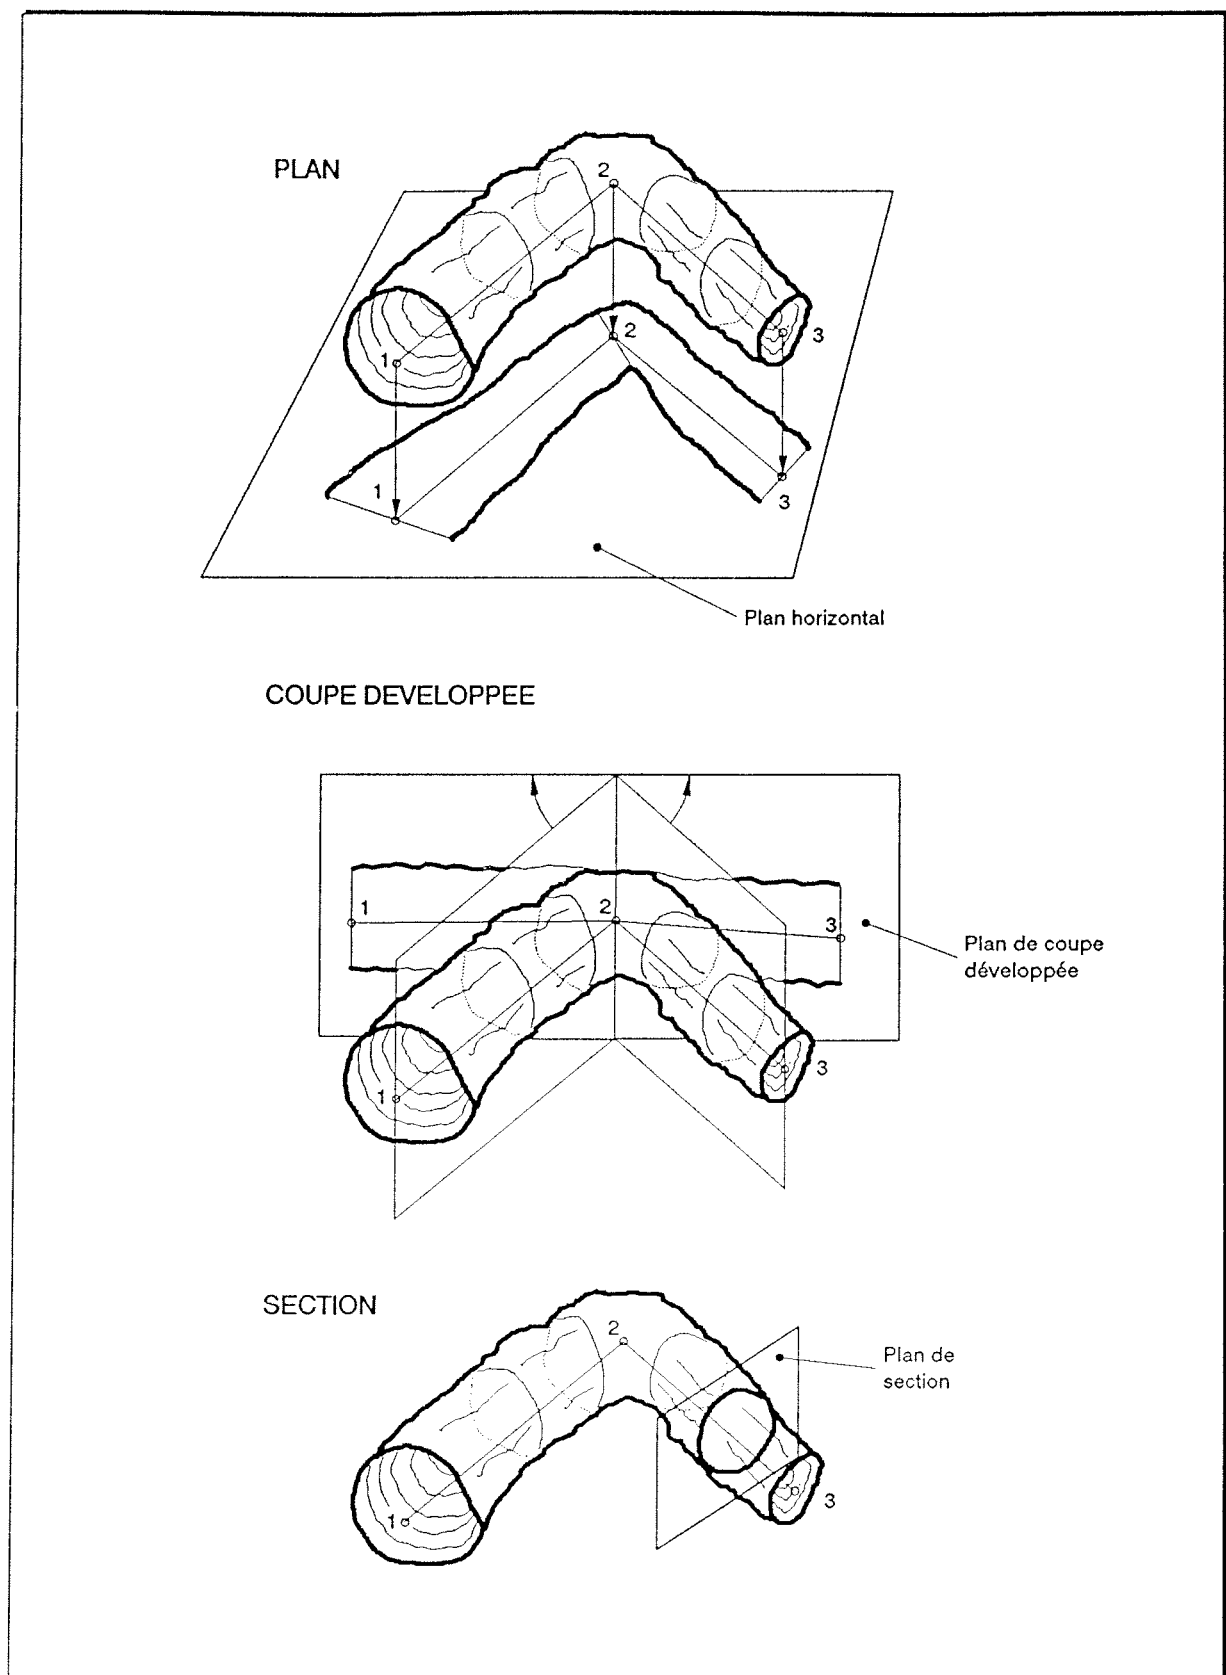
Modes de représentation en plan, en coupe et en section
